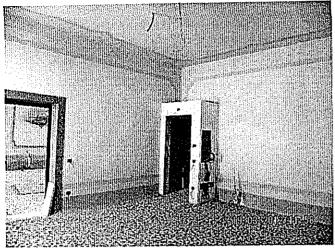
Stanza 1.8- Parete lato interno e porta sala
